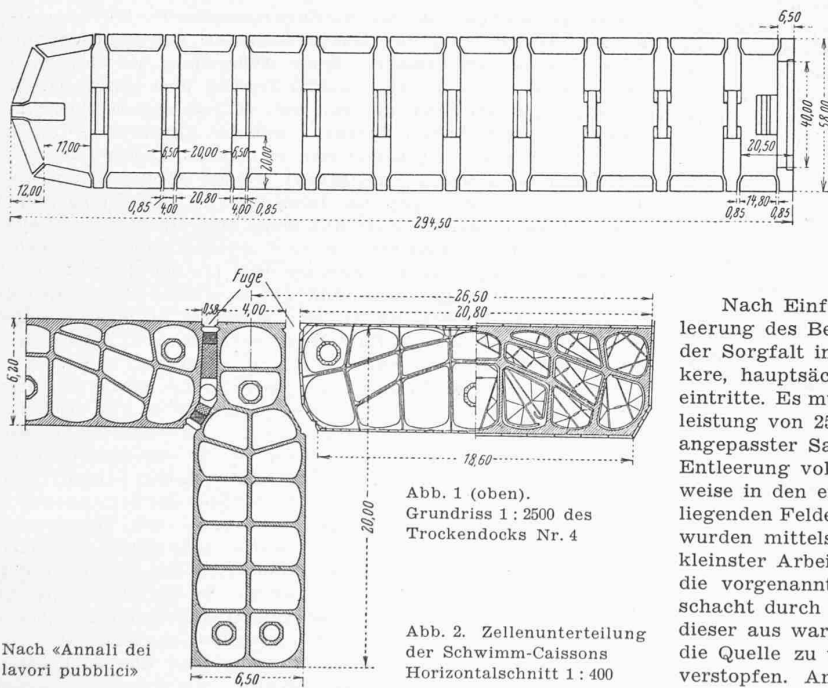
(oben). Grundriss 1 : 2500 des Trockendocks Nr. 4
